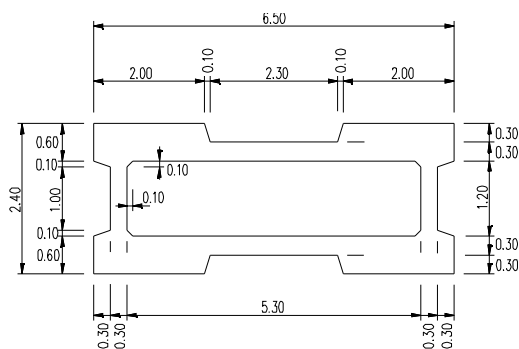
Secção transversal dos pilares P6 a P14.
